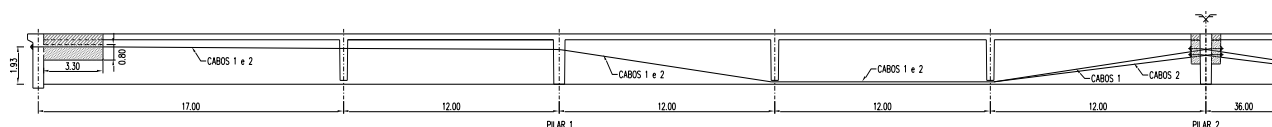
Traçado do cabo de pré-esforço exterior de metade do tabuleiro (adaptado de ARE,2003).
